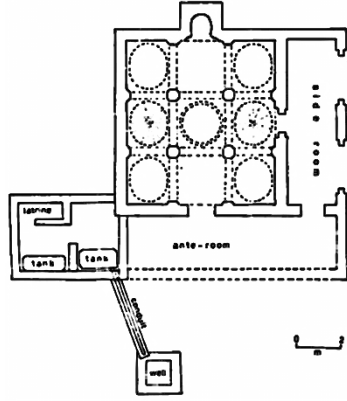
مسقط أفقي لمسجد تنجوني الجامع/ تنزانيا
